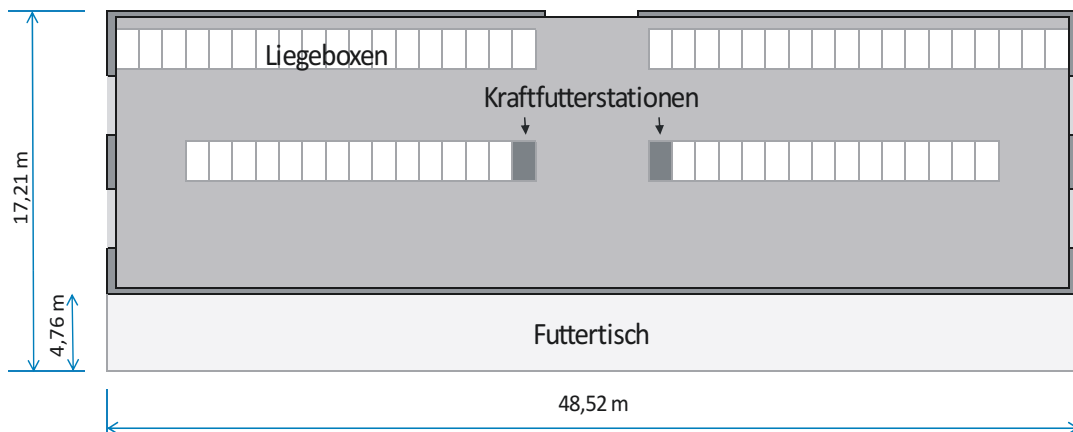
Grundriss des Milchviehstalles - Gut Frankenforst
